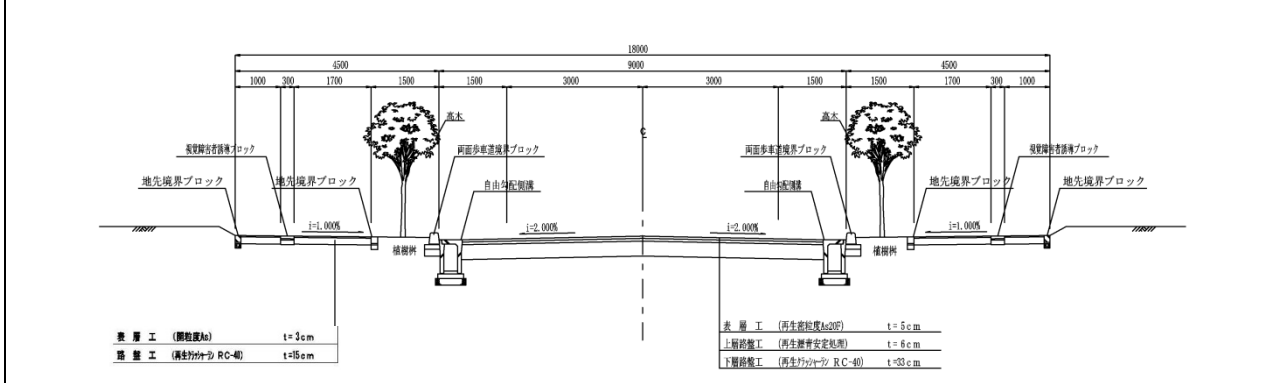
(1) 道路断面図(幹線道路:18m 標準断面)
